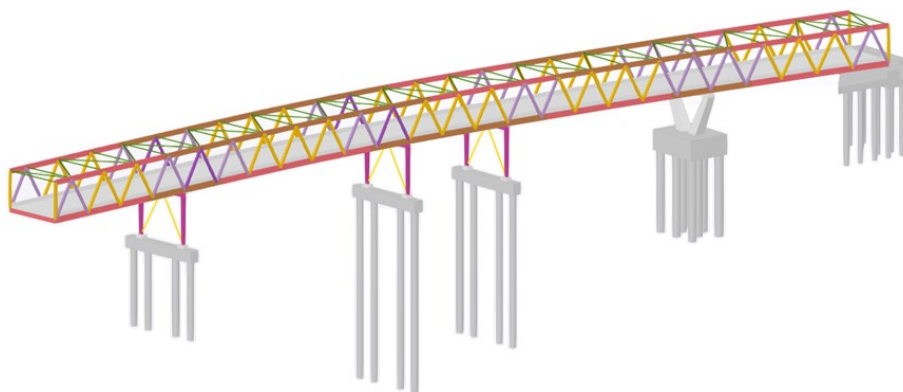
Vista tridimensional da estrutura do Viaduto isolado
